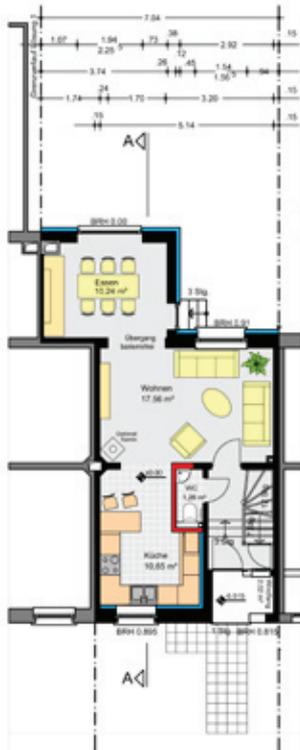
Grundriss Erdgeschoss Einzelhaus
